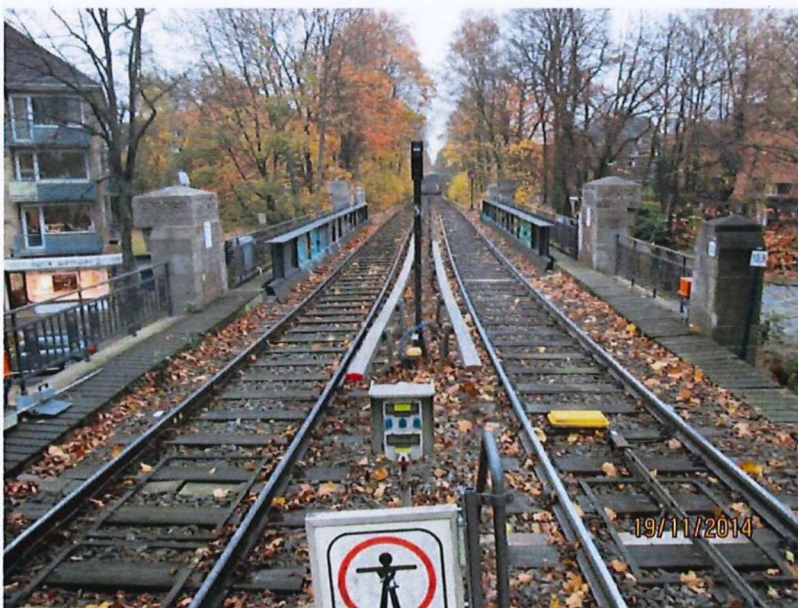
(Blick zum Brückenbauwerk vom Bahnsteig).
